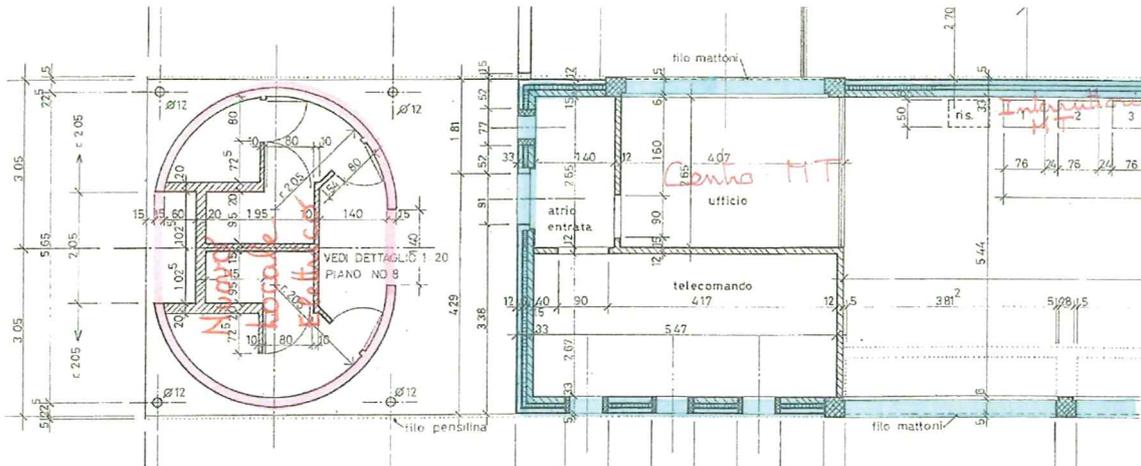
Piano locale BYPASS e Centro MT in Via Delta
